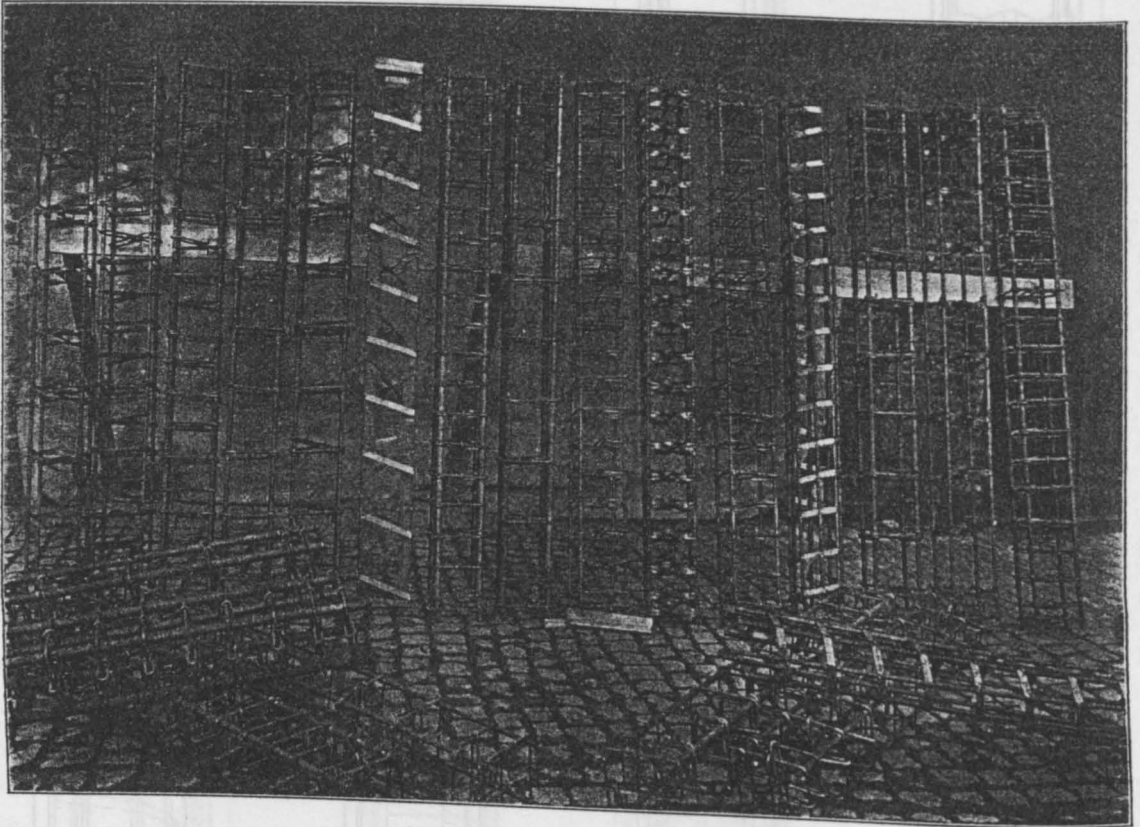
Armierungen der Säulen vor dem Einbetonieren.
